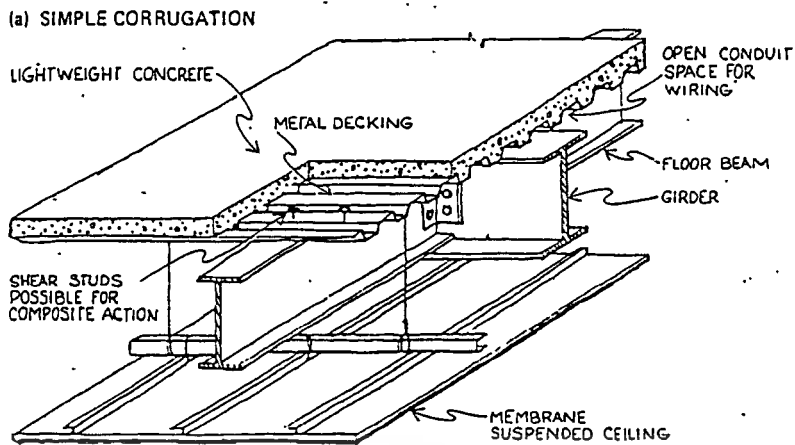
แสดงคอนกรีตเสริมเหล็กระบบ JOIST AND GIRDER
